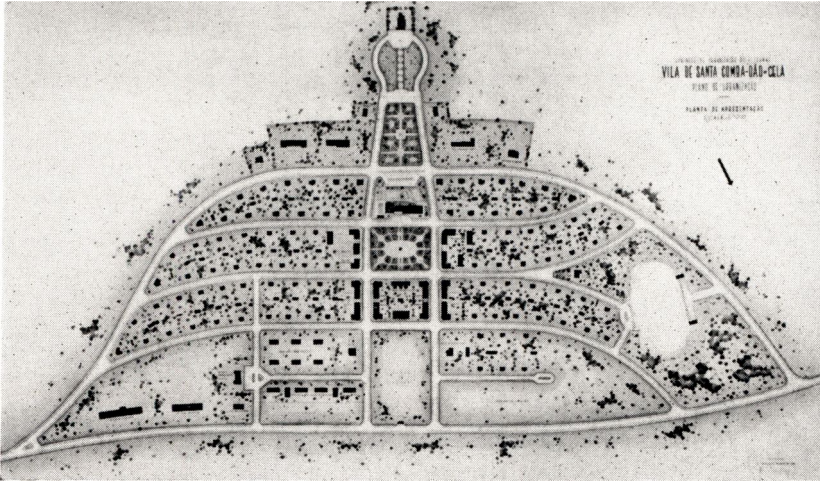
Vila de Santa Comba Dão — Plan de masse
